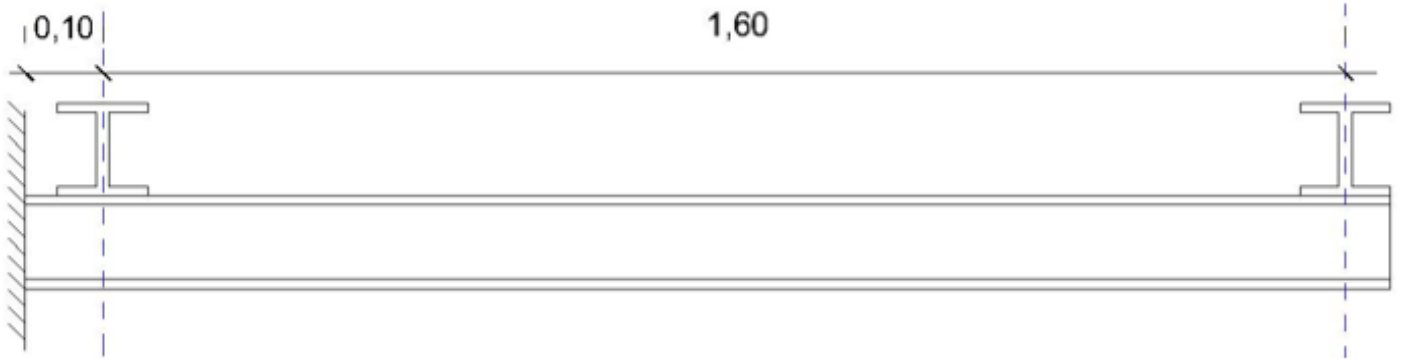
Detalle del apoyo de las vigas longitudinales sobre la ménsula
